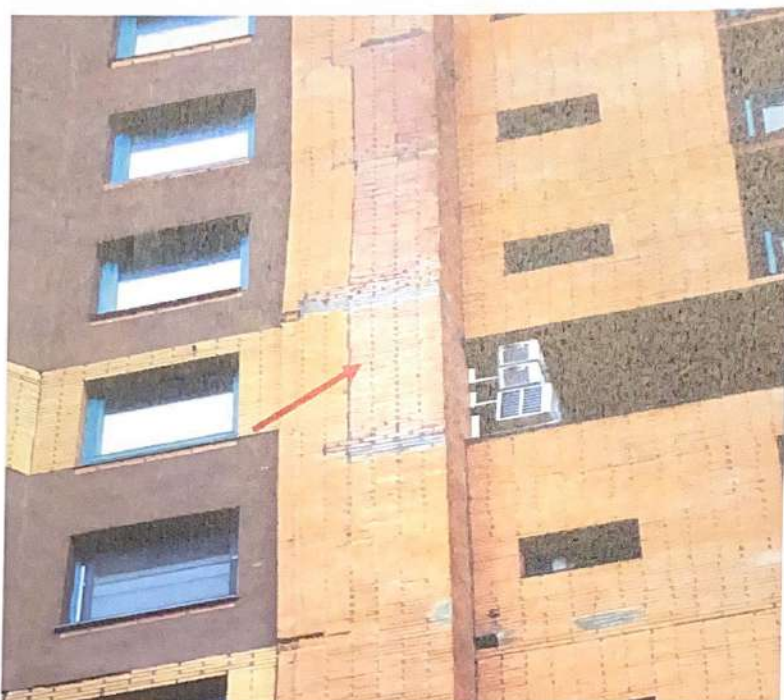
Секция 11. Фасад 2. Участок восстановления кирпичной кладки фасада.
